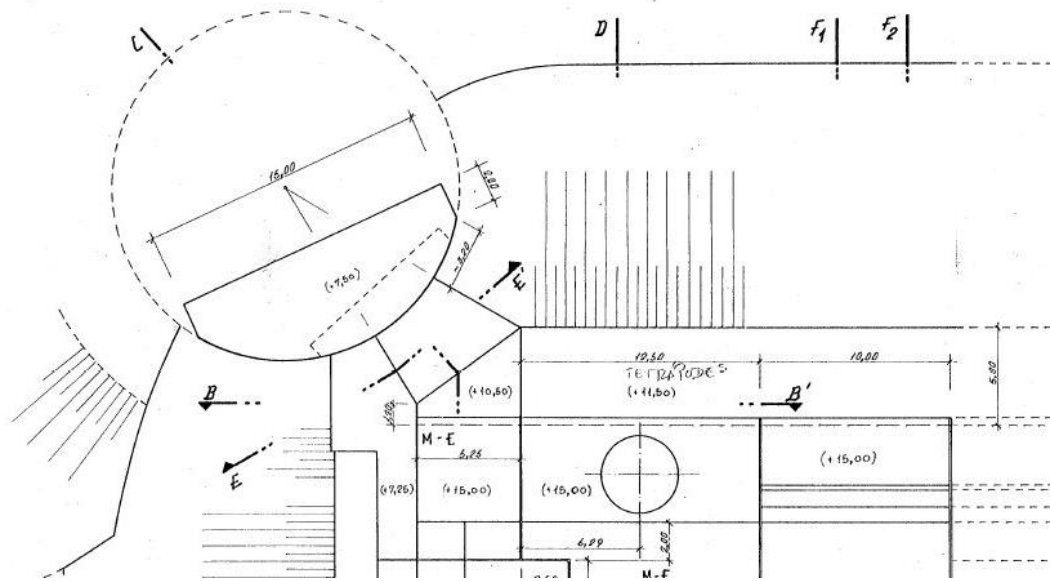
Figura E – Planta da zona da cabeça do quebramar Norte (APDL, 1973).
